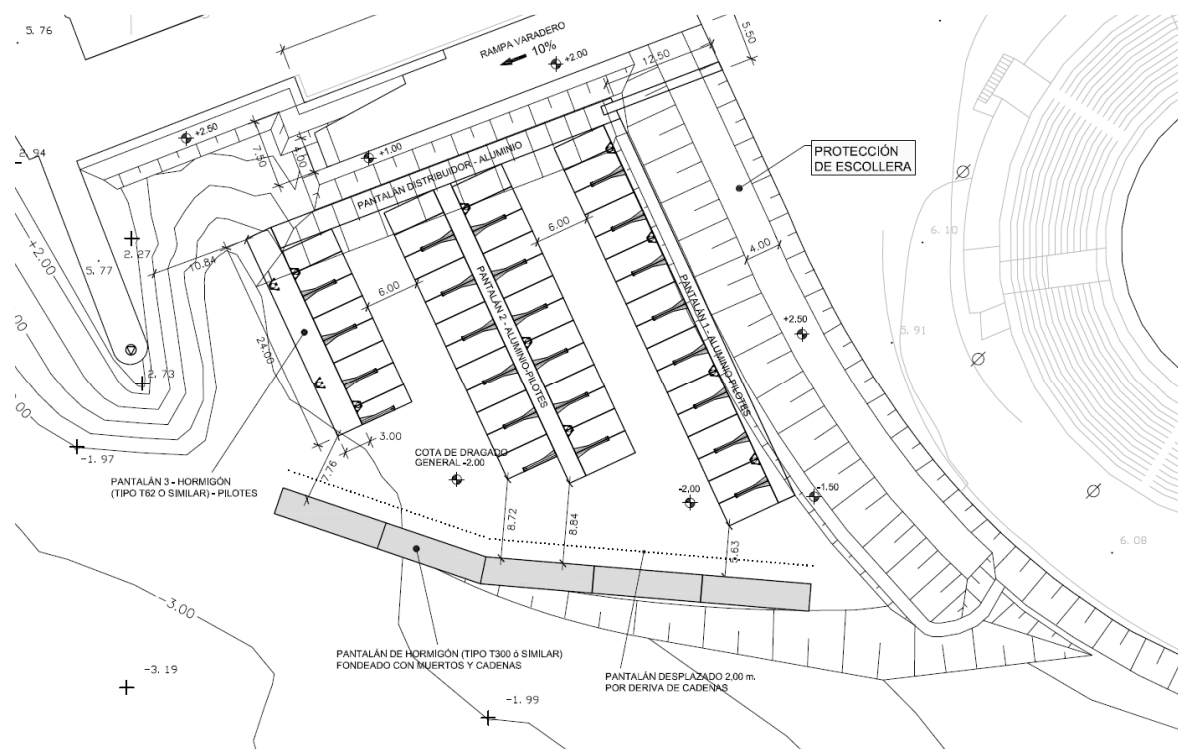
Planta del proyecto construido en el año 2008 con calado en la dársena a cota -2.00 o inferior. Fuente: Egenor, 2008
